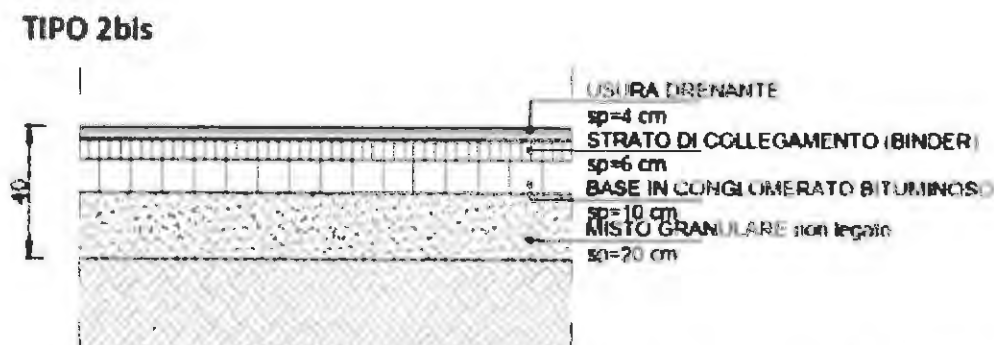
Sezione TIPO 2bis progetto esecutivo – inizio rampe Svincolo Sud e rampa D Svincolo Nord
